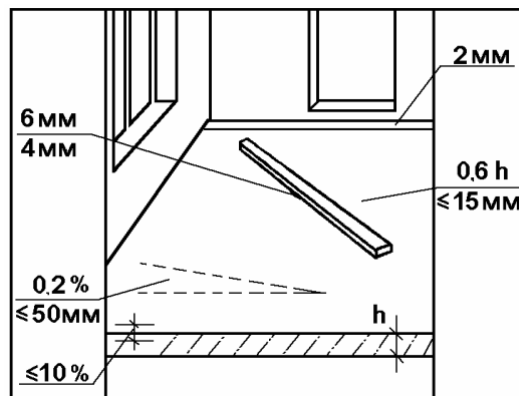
Відхилення, що допускаються, при бетонуванні перекриття.
